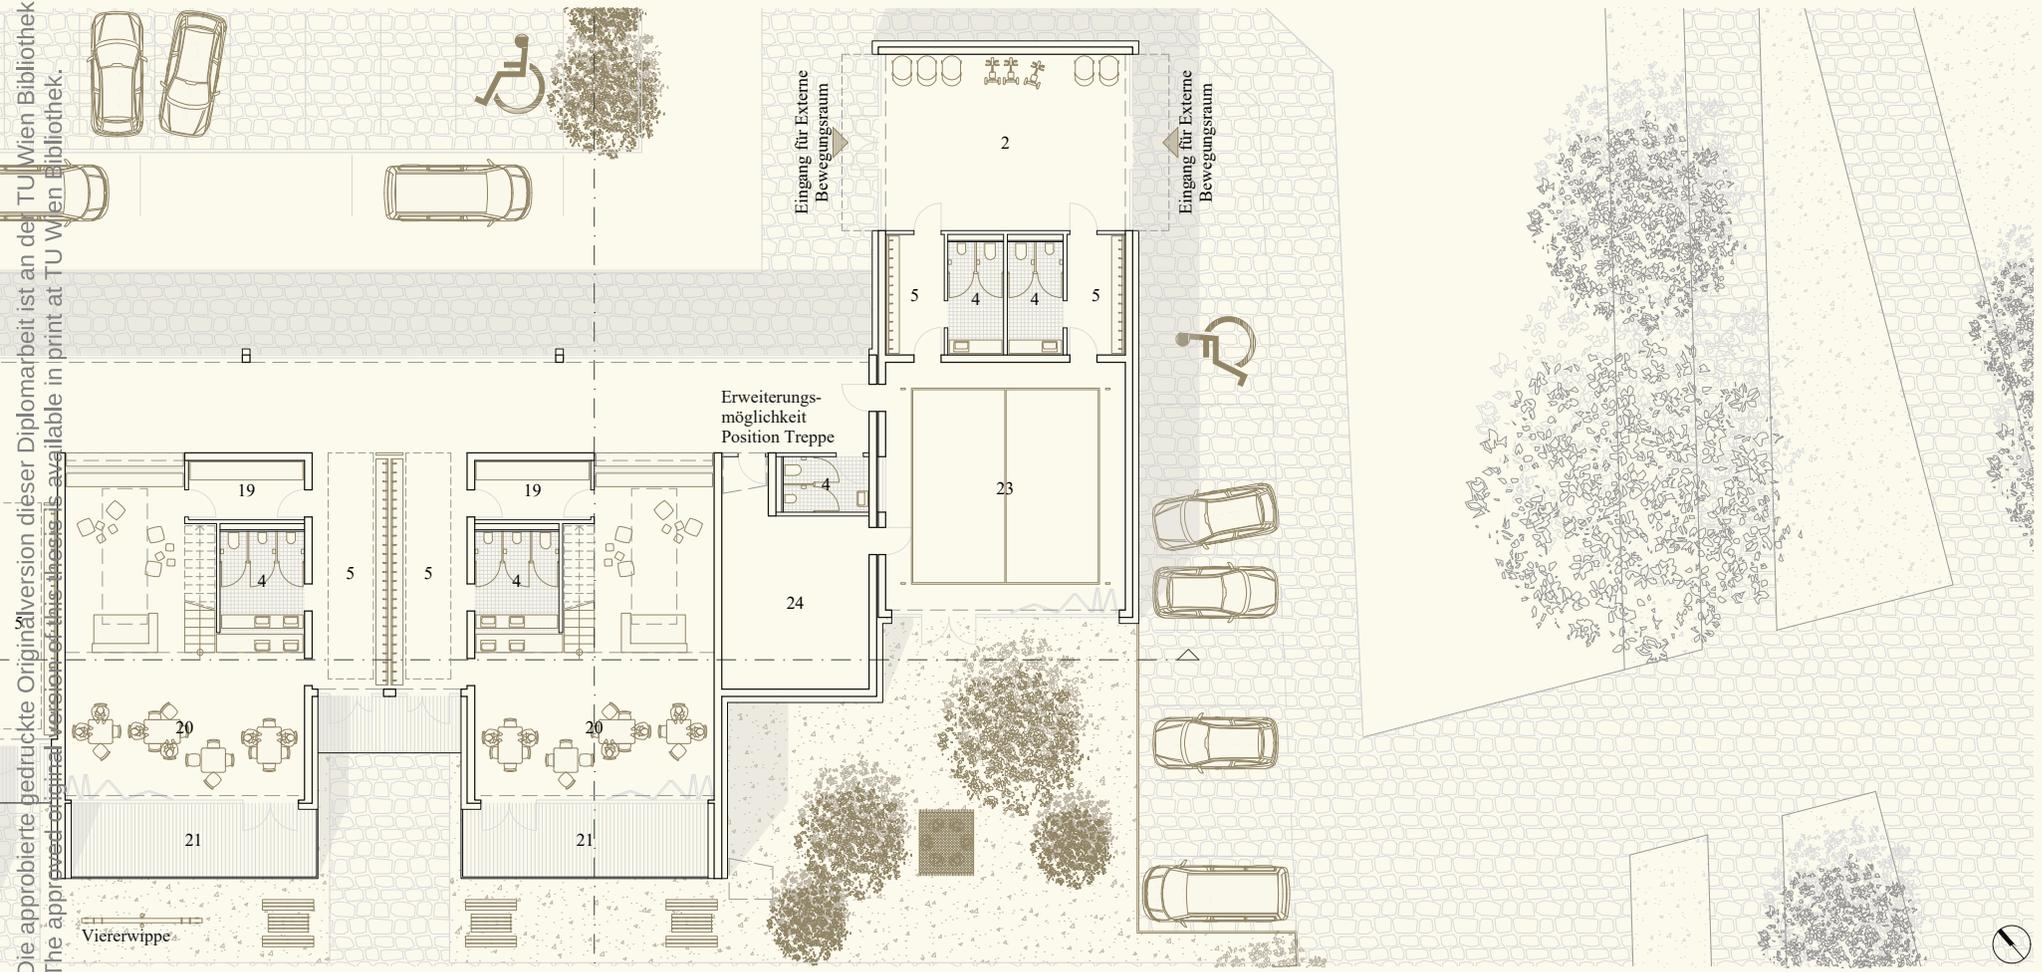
, Grundriss Erdgeschoss | 1:250
